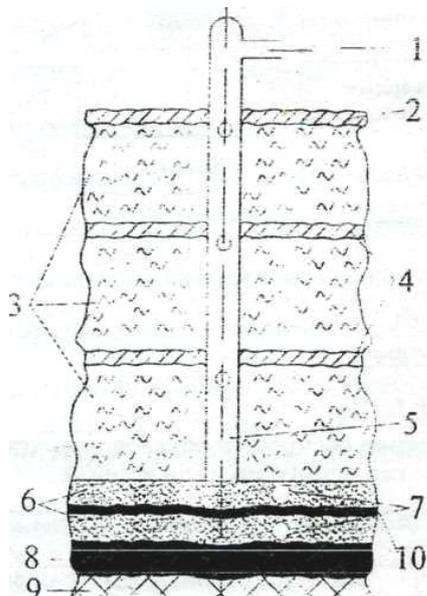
Схема сбора биогаза на полигоне ТБО:
